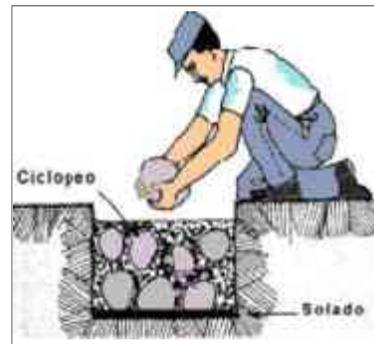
Pegado de piedra. Fuente: Tripod cimentación, <http://annlinet.tripod.com/CIMENTACION.htm>, 28/03/2014.
